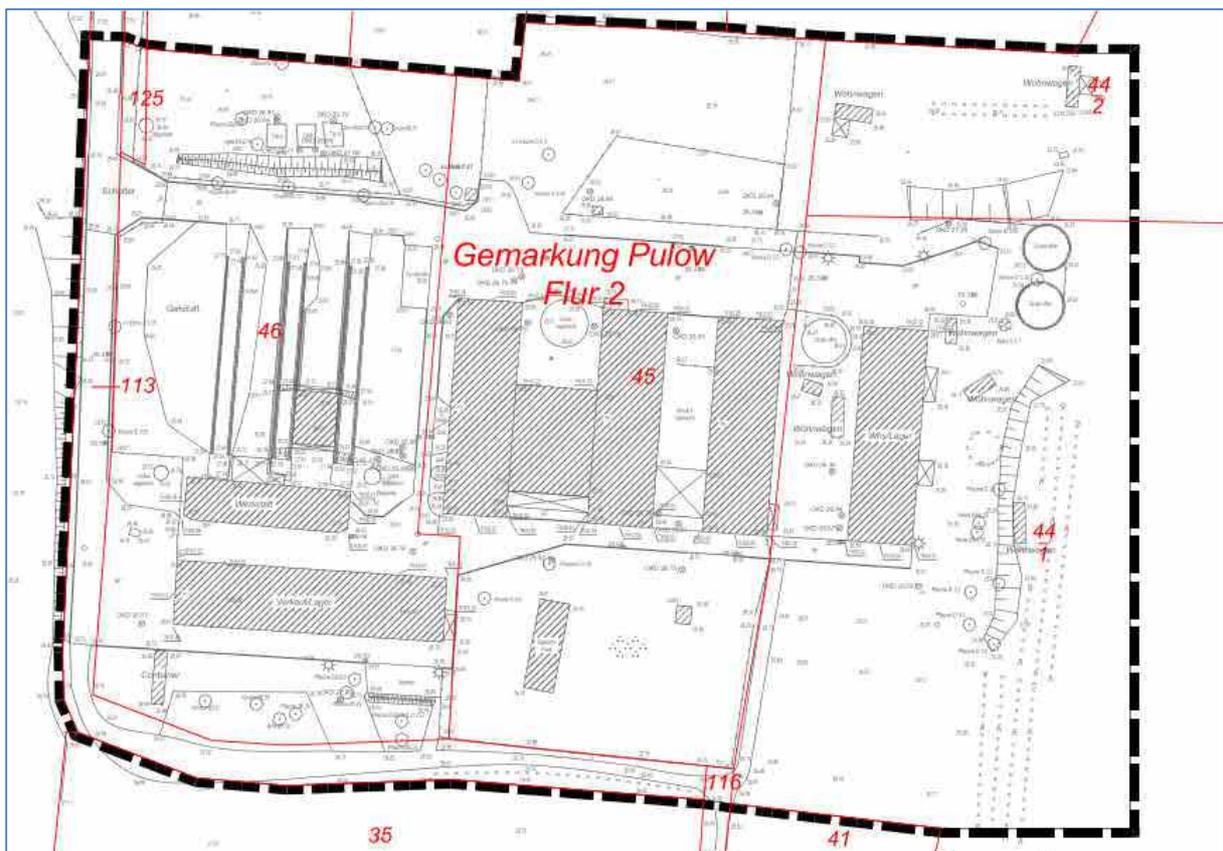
Übersichtslageplan mit Abgrenzung des Geltungsbereichs (Quelle: NUP)
